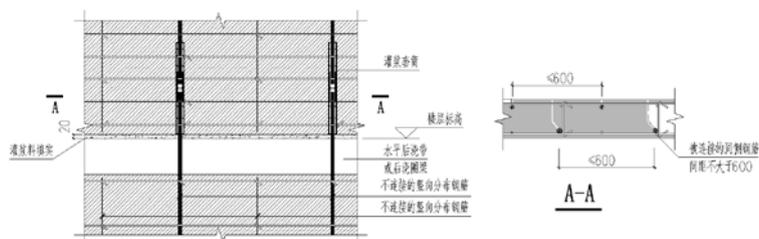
预制剪力墙竖向分布钢筋连接构造示意
